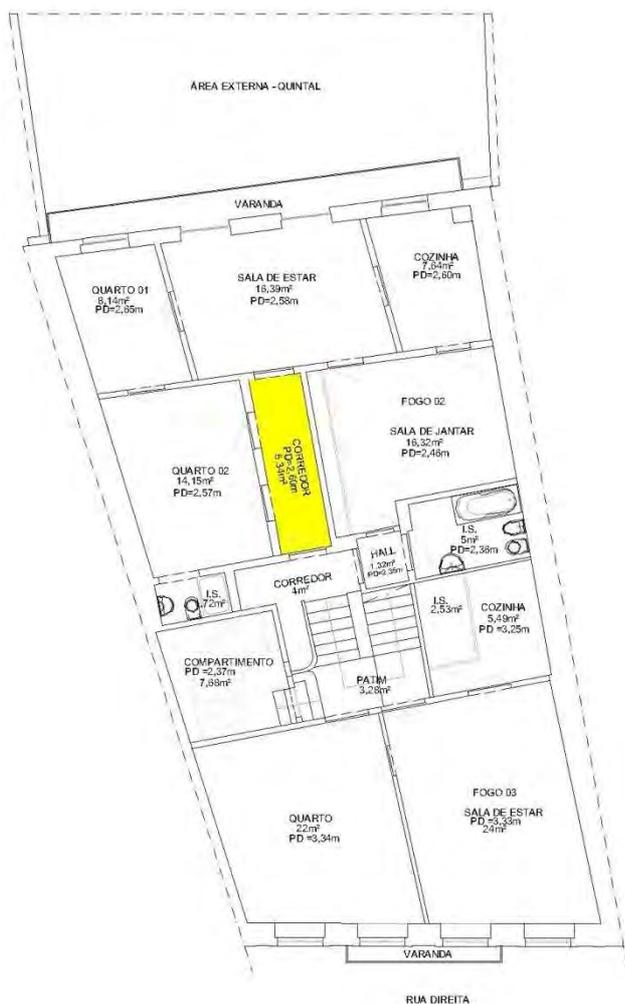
Planta do primeiro e segundo pavimento com destaque para o corredor do fogo 02.
